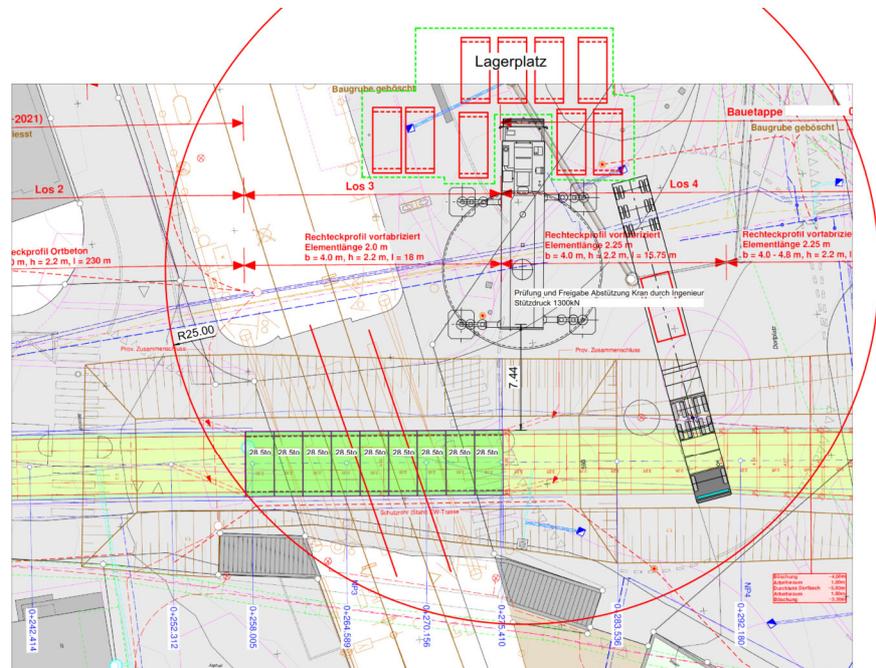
Installationsplan, Montage Elemente SBB (Quelle: Fanger Kies + Beton AG, Sachseln)
